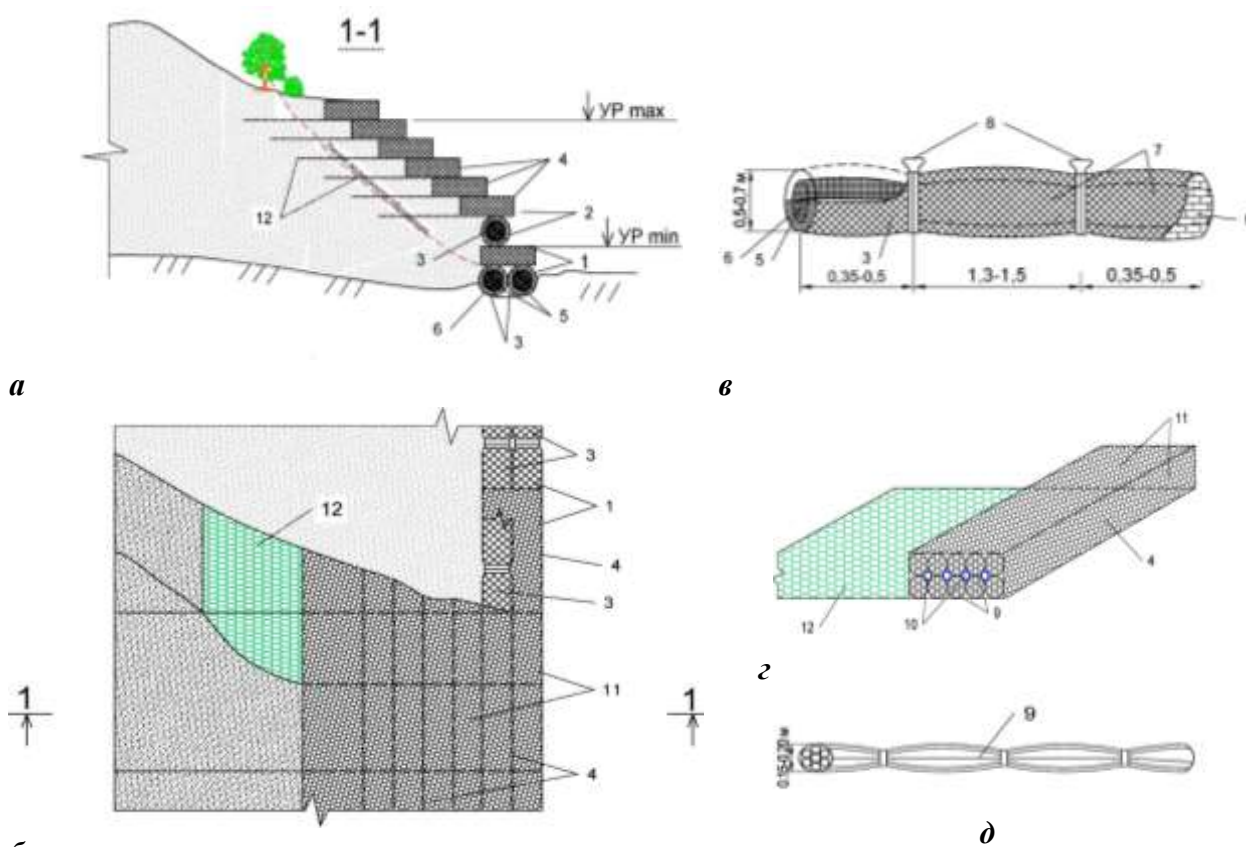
Подпорные стенки для защиты прибрежных зон от обрушения и размыва
